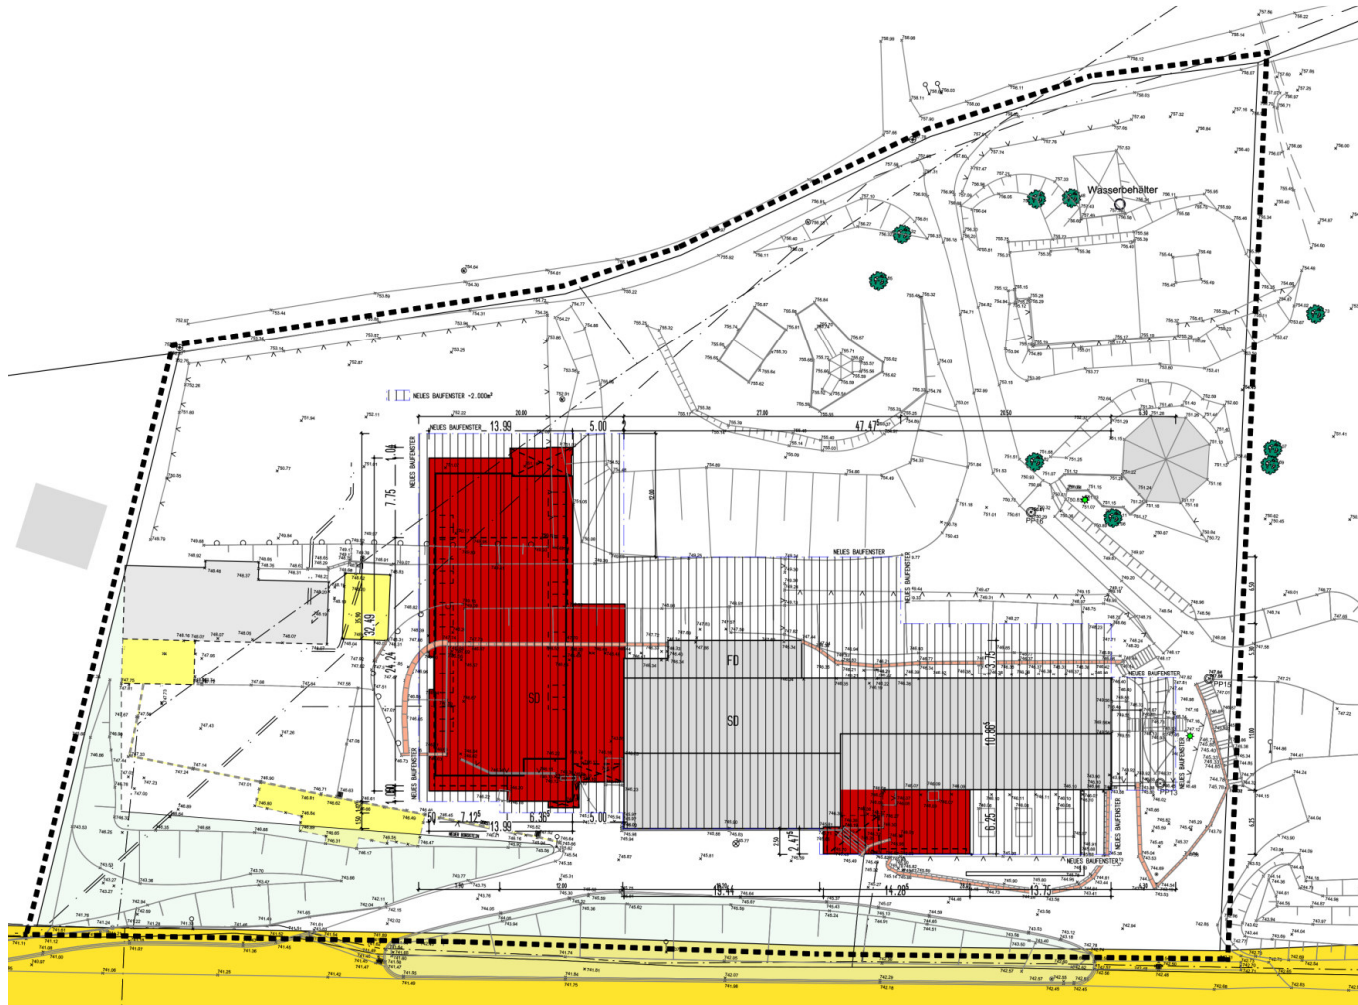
geplanter Um- und Neubau, Lageplan M 1:500 (im Original), Architekturbüro Ohm + Ohm, Olpe, Stand: 03.09.2014
